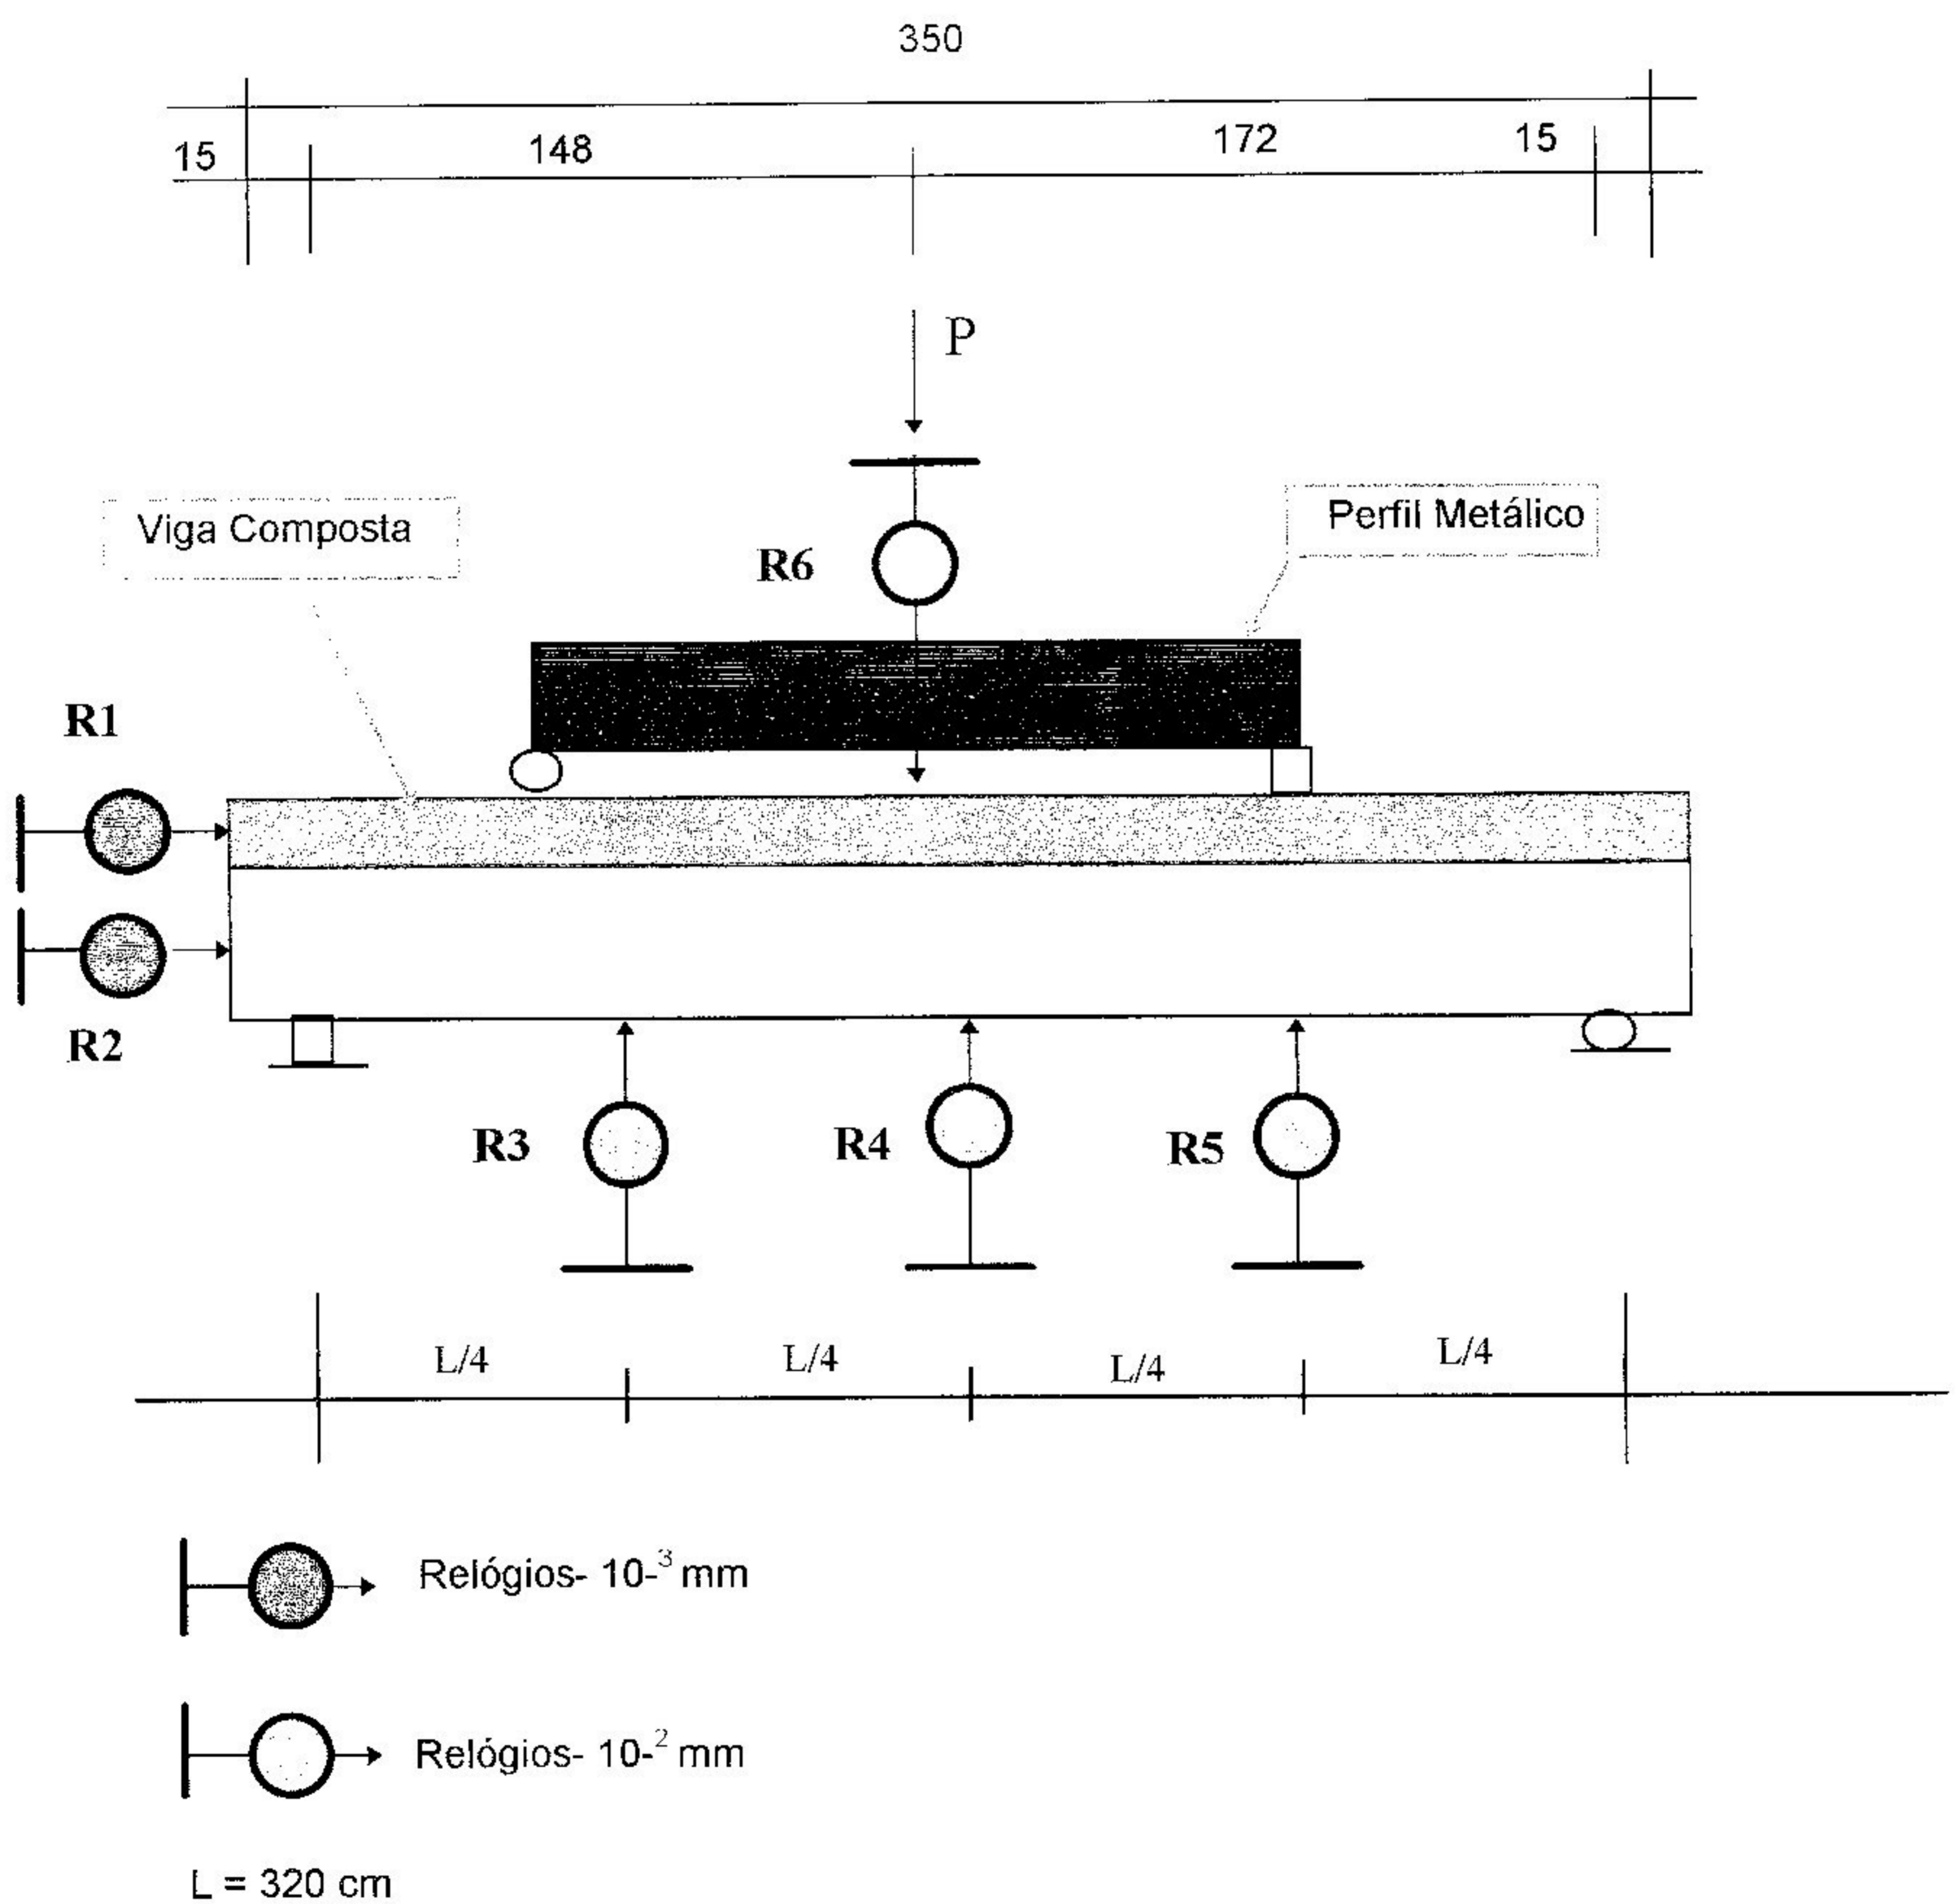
a - Esquema de Ensaio de Flexão da Viga Composta Madeira/Concreto
